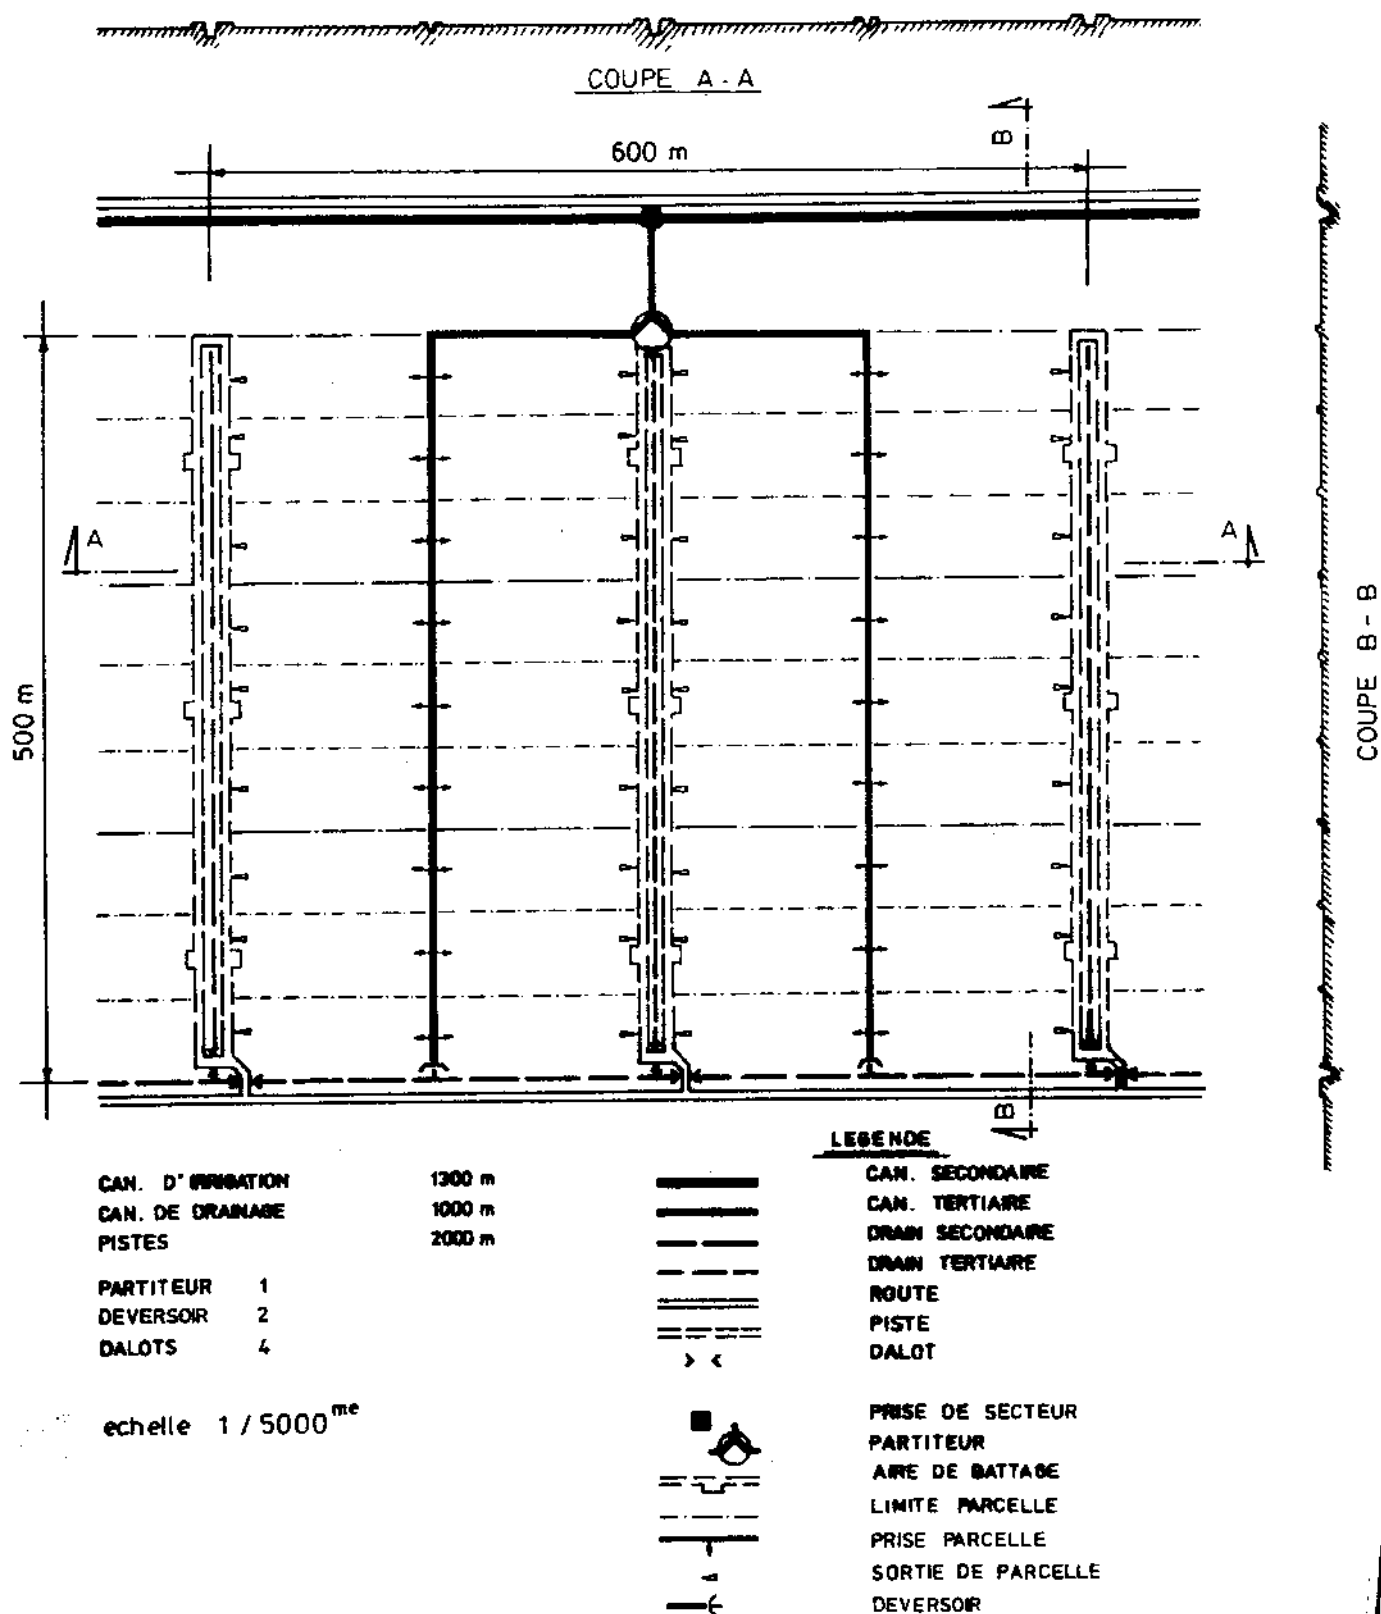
PLAN TYPE D'UN SECTEUR D'ENVIRON 30 ha
